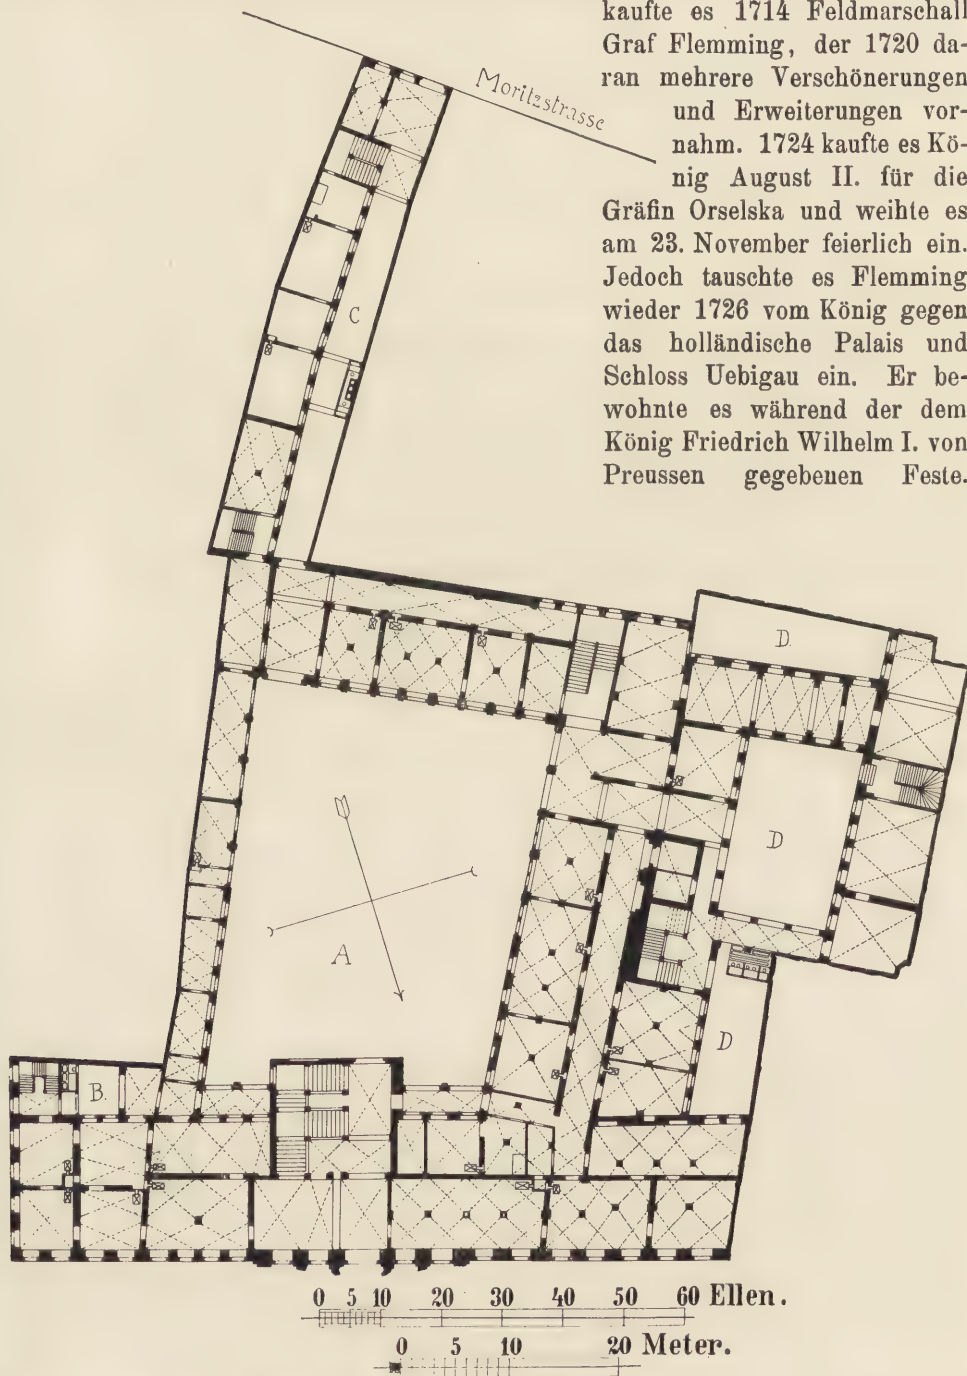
Flemming'sches Palais, Grundriss des Erdgeschosses. Zustand von 1747.
